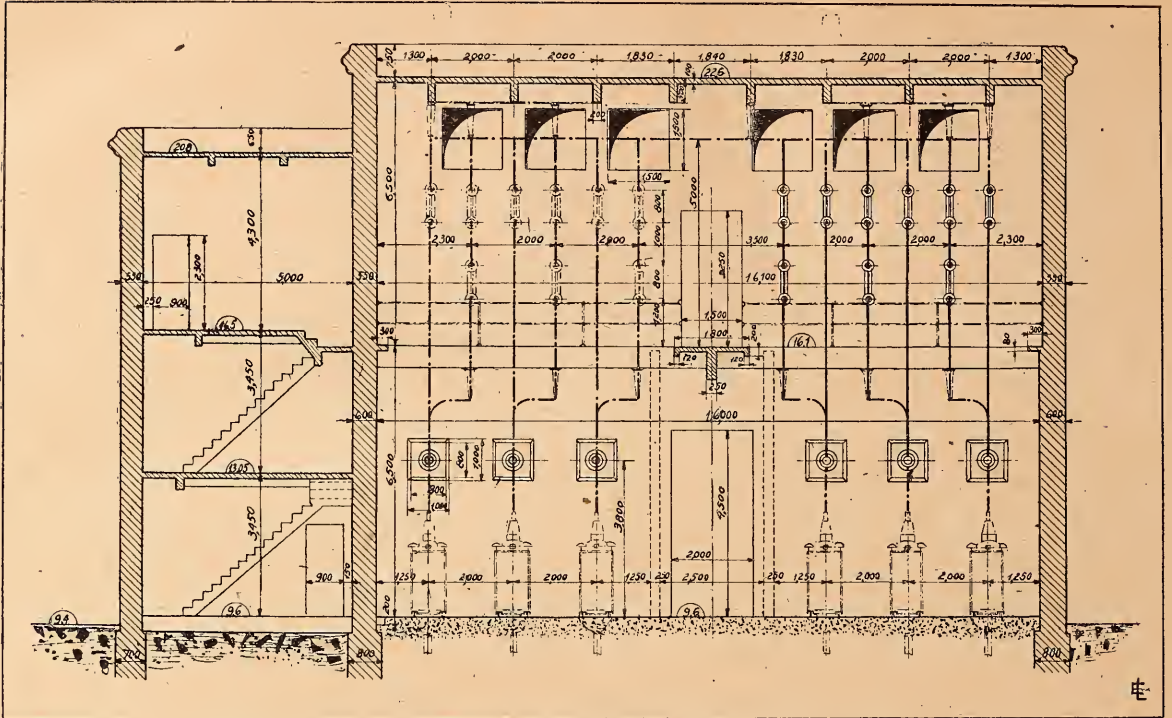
Porte de Delle : Coupe suivant C D (Voir fig. 3).
